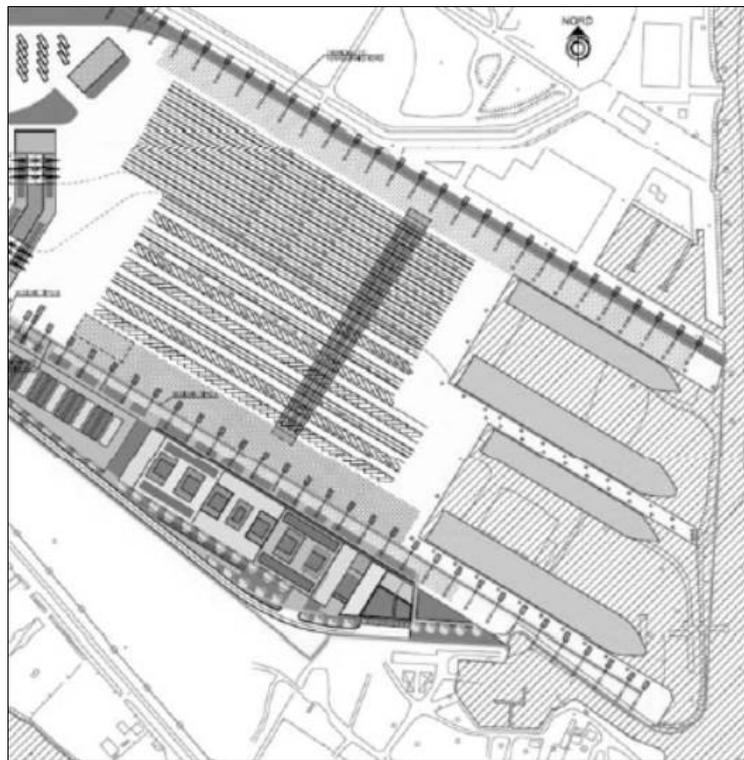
Dettaglio della planimetria del layout del terminal per la porzione delle darsene
